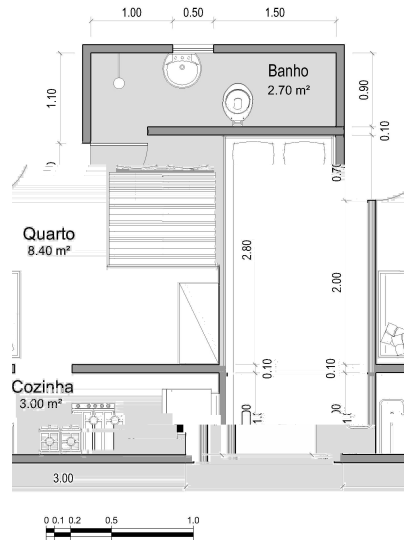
Planta baixa de 11,17 m<sup>2</sup>.
